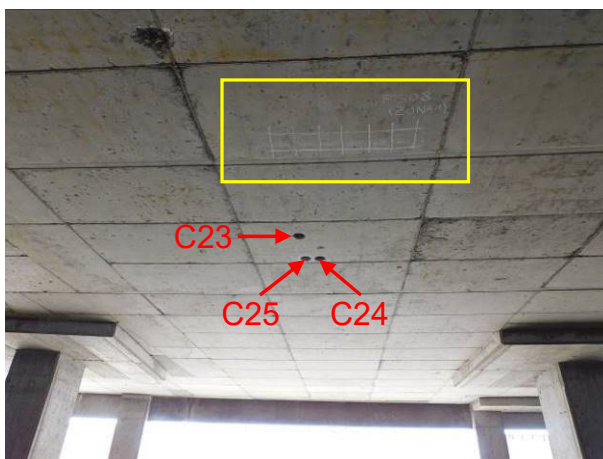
Idem. Piso 7. Zona Z(8).1, com deteção da malha de armaduras na face inferior da laje de pavimento do piso 8, com recurso ao equipamento detetor de armaduras (pacómetro), para extração de três carotes (designadas de C23, C24 e C25) destinadas a ensaios laboratoriais (ensaios de compressão). Localização da zona de ensaios esclerométricos e ultrassónicos, através do método indireto (assinalada a amarelo).
